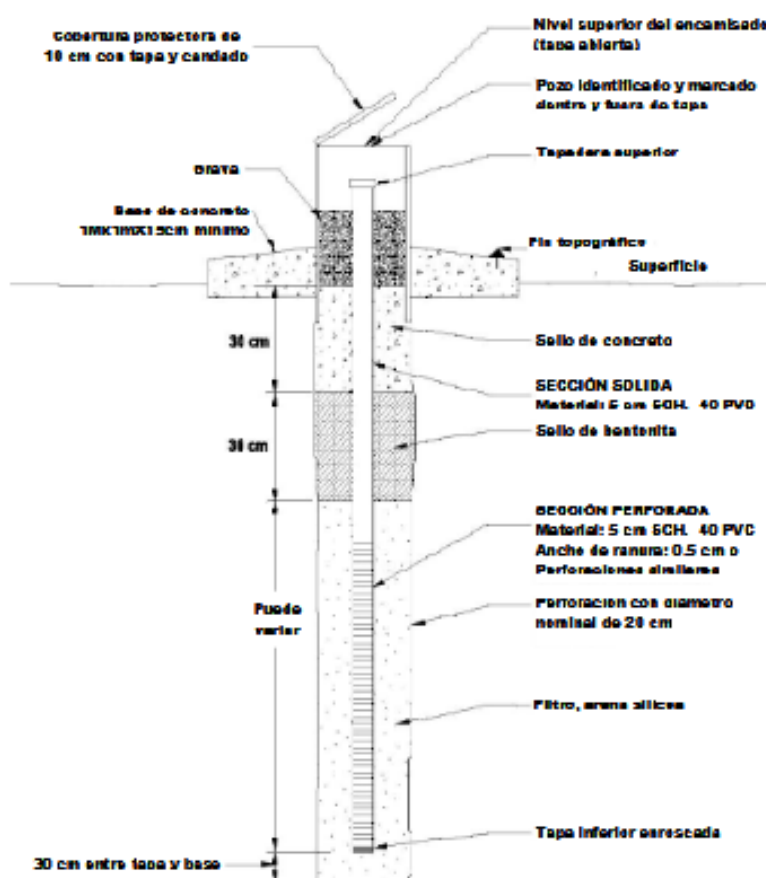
Infraestructura post clausura - Pozos de monitoreo
